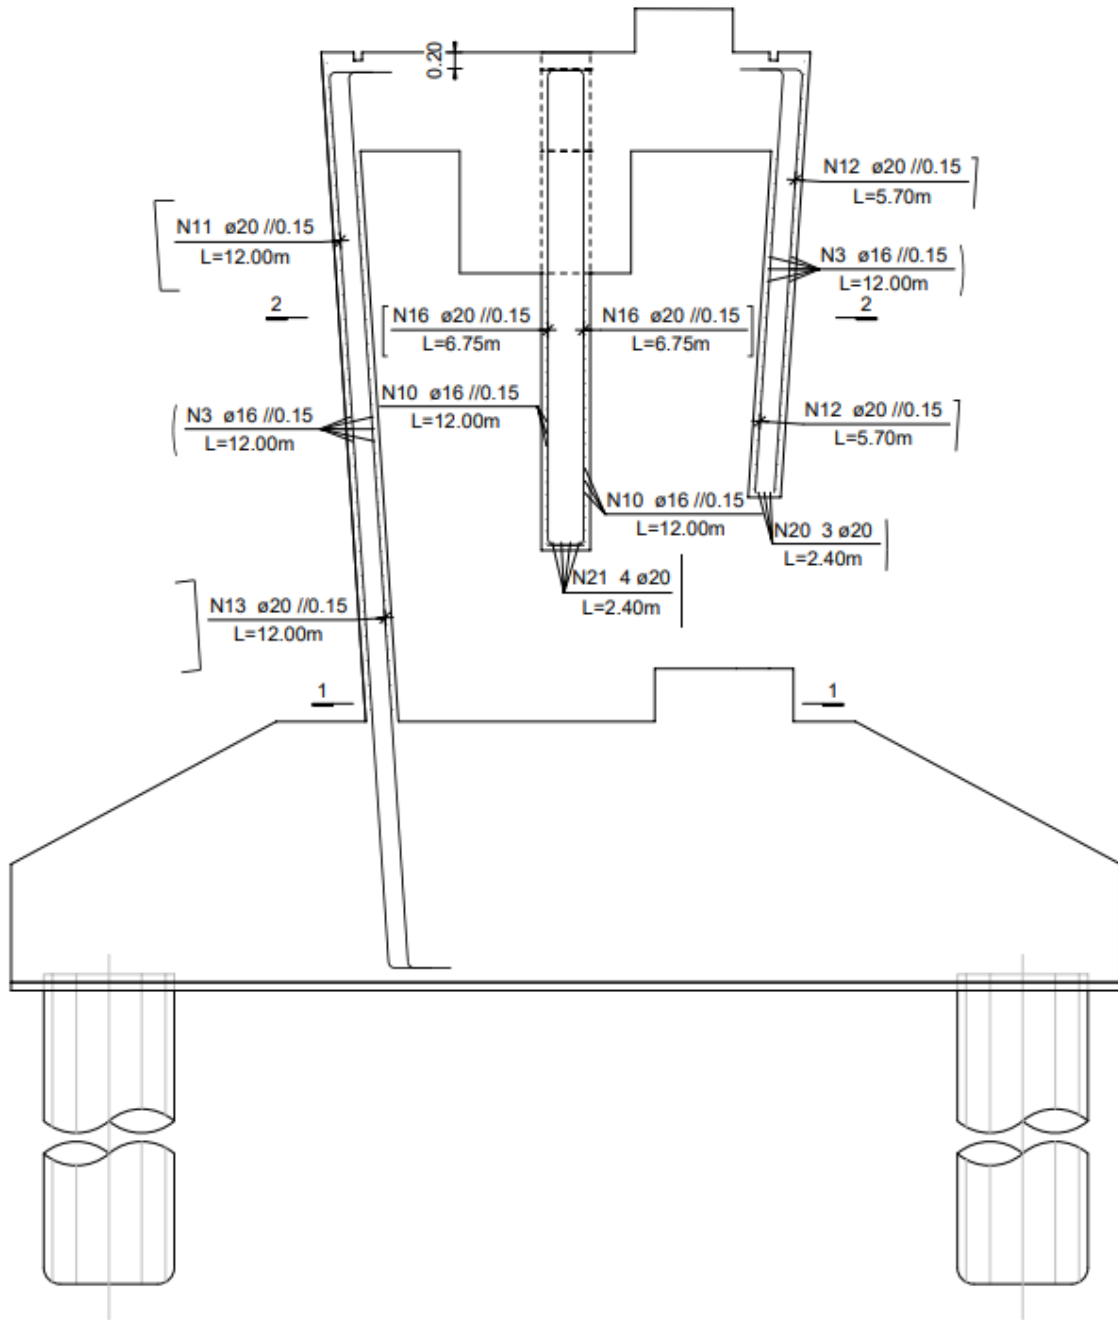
Corte vertical do pilar PC1 com representação das armaduras e etiquetas
